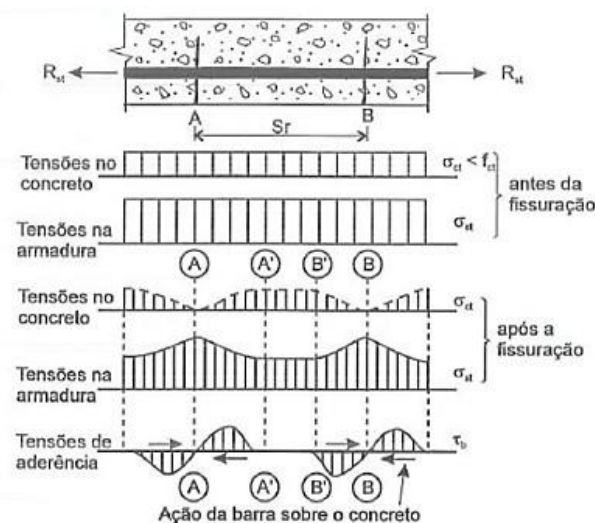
Fissuração no concreto submetido à tração [6].
